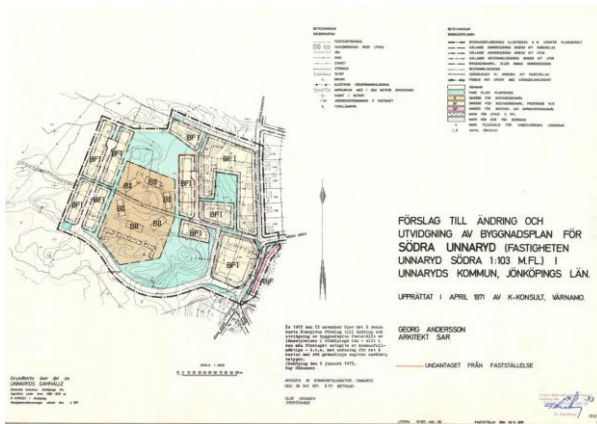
Gällande detaljplan Un 515 – Unnaryd 1:103 m.fl.
